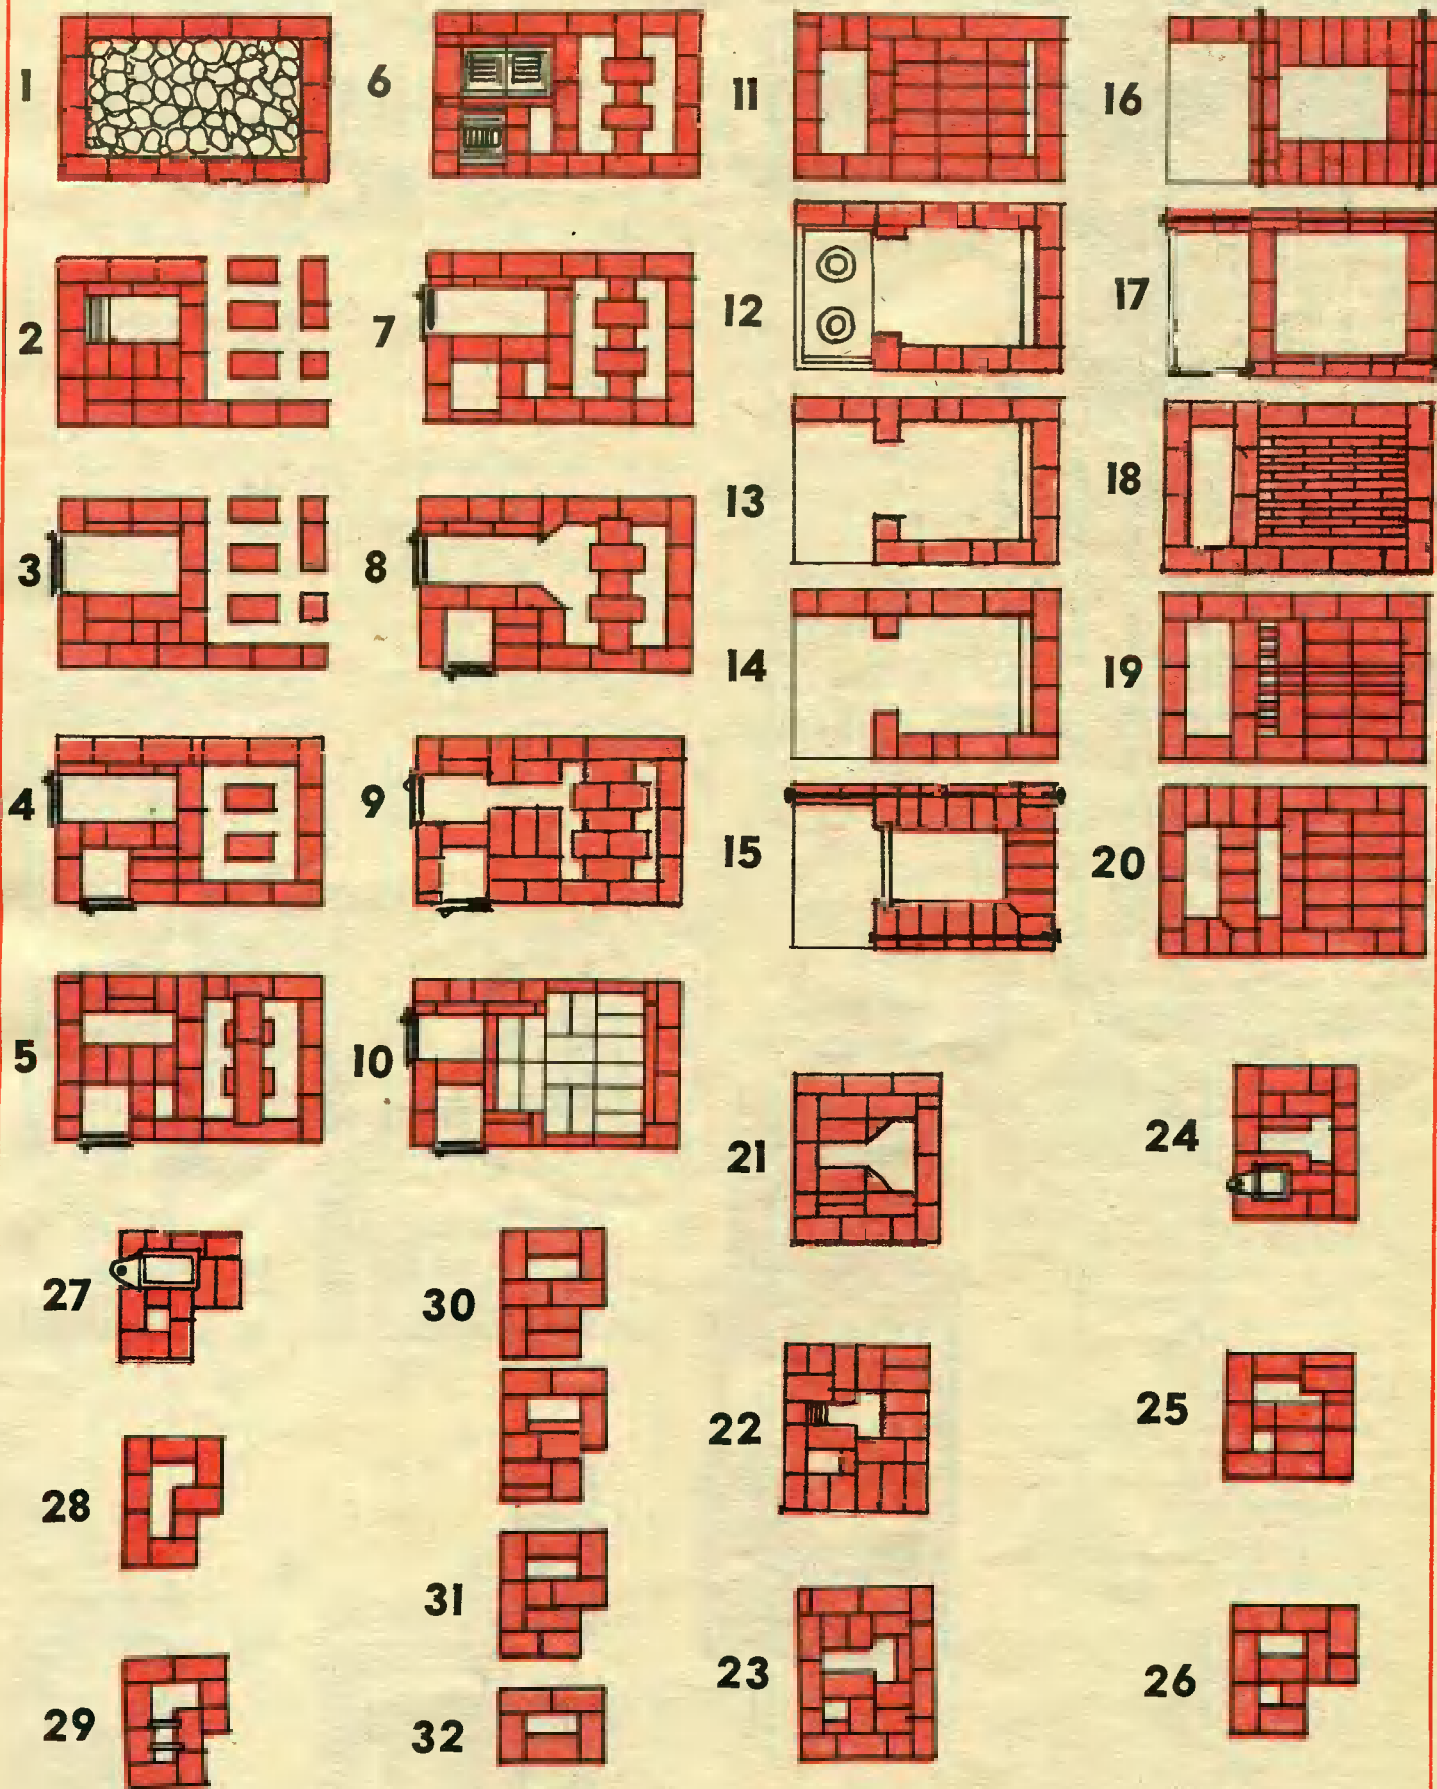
Вся печь Шепелева от фундамента до трубы состоит из 32 рядов.
